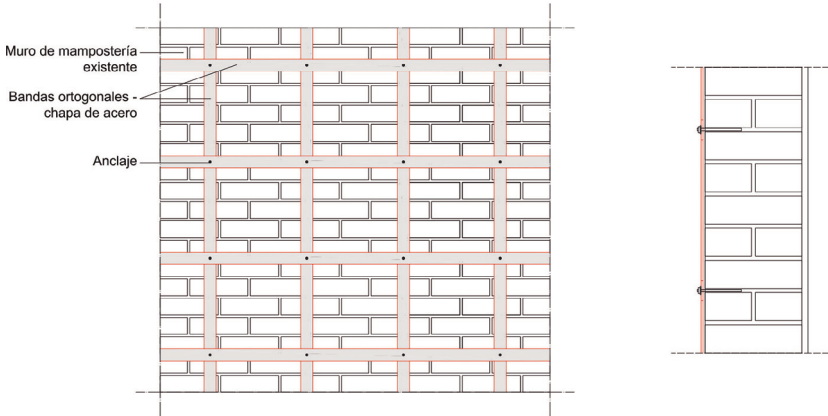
Malla rectangular de bandas de acero. Esquema y detalle constructivo.
